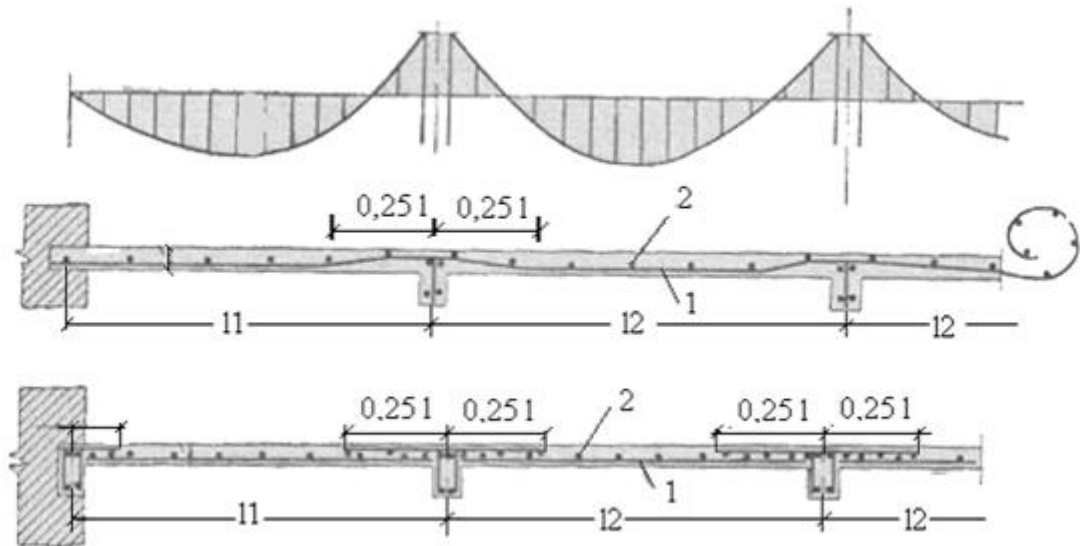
Армування нерозрізної плити (два варіанта)
